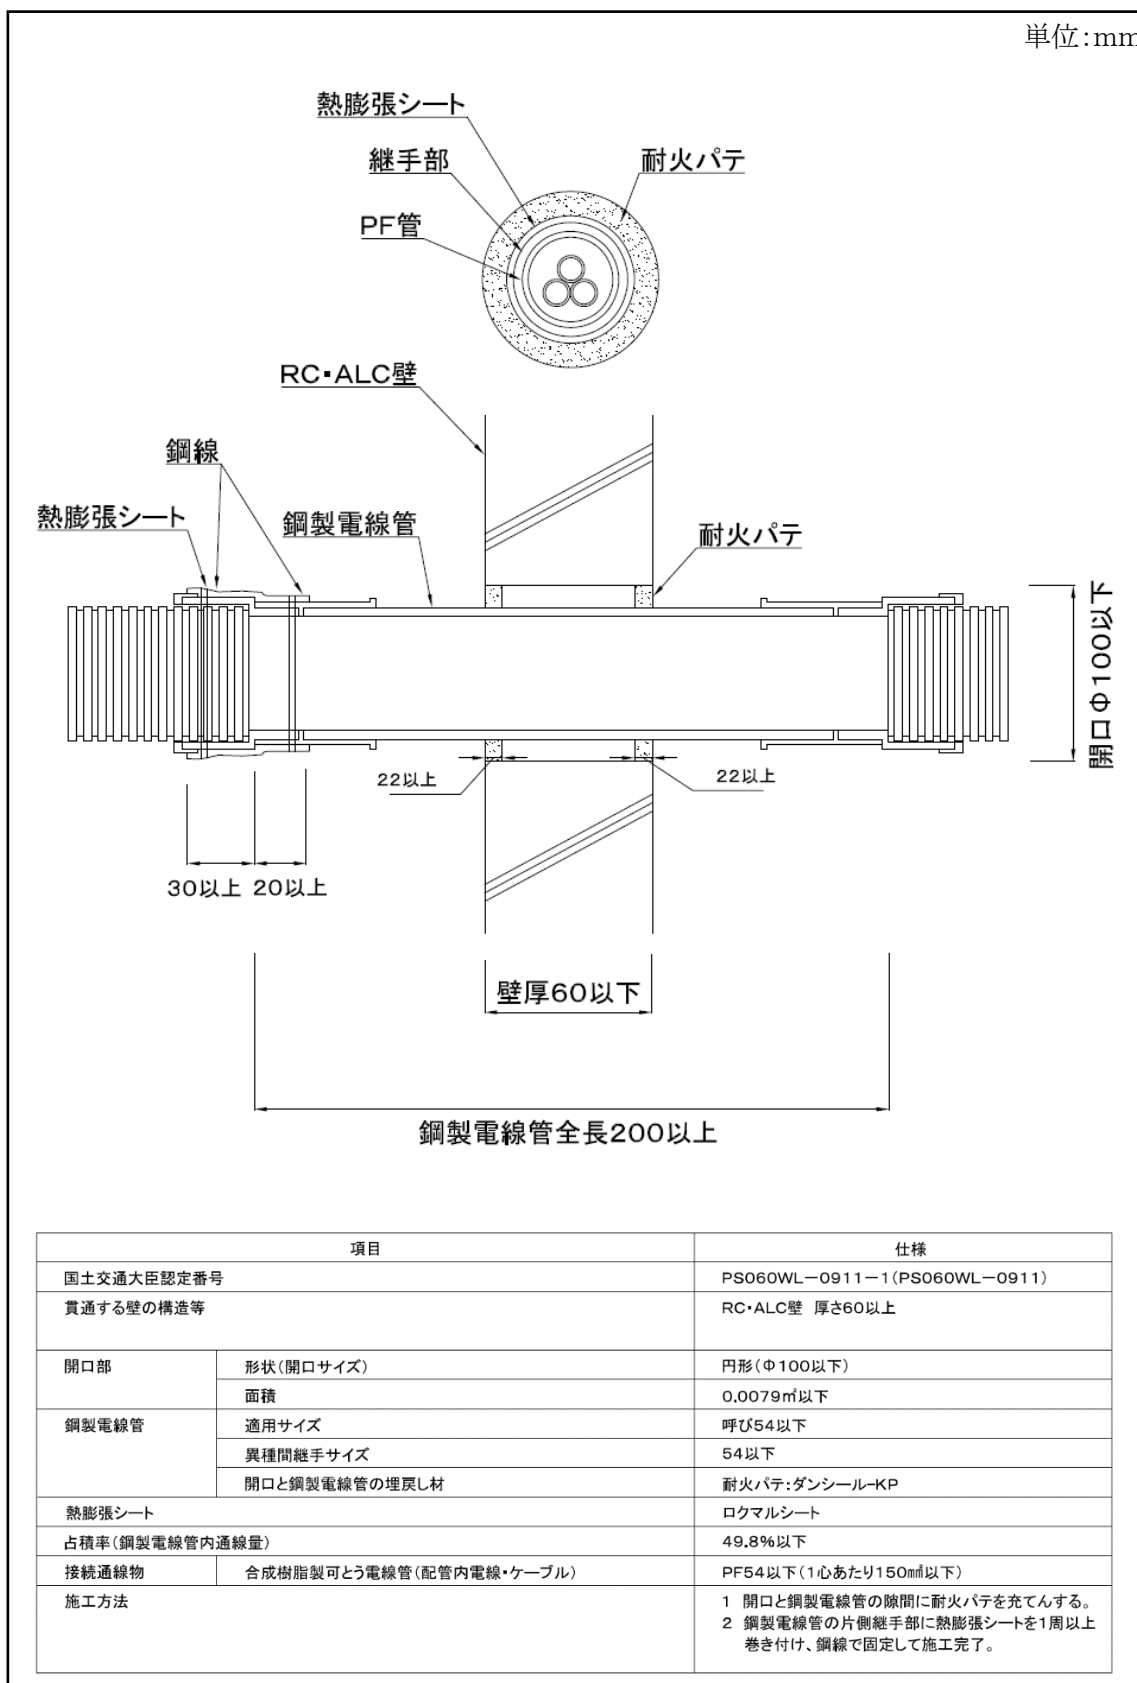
鉄筋コンクリート(RC)・ALC 壁(PS060WL-0911-1(PS060FL-0911)) 標準施工図
